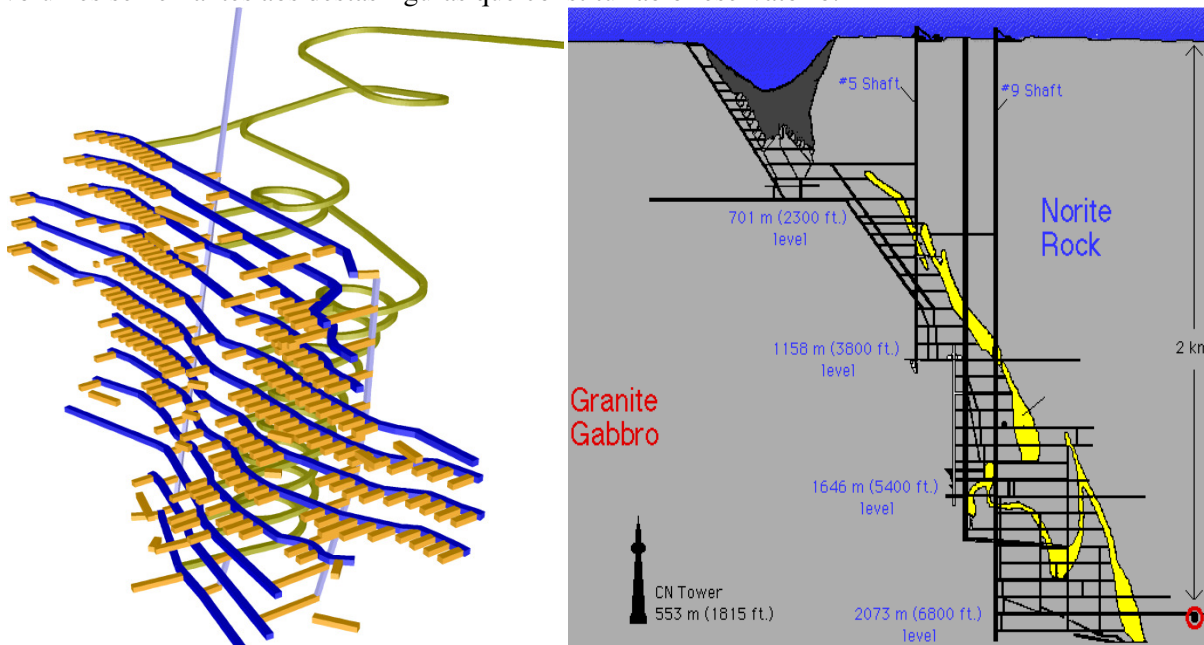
Vistas tridimensional e corte vertical de minas (Met-Chem, 2010; LIP, 2010)
